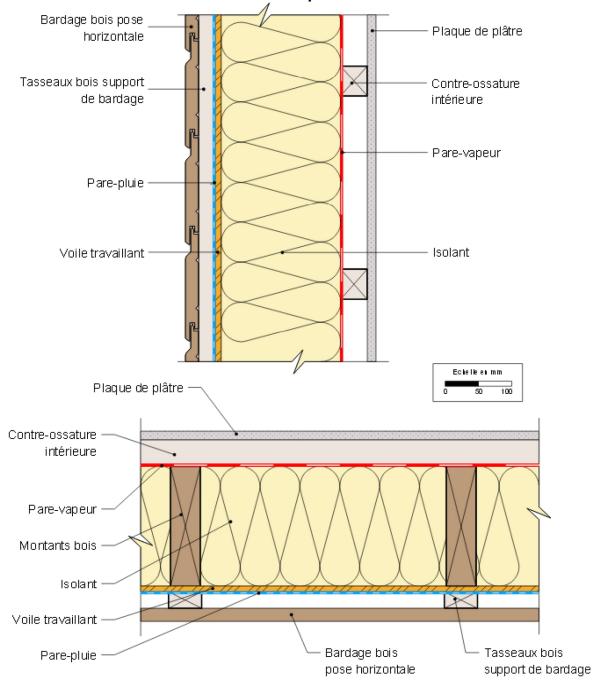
Contreventement extérieur (coupe verticale en haut, verticale en bas)
